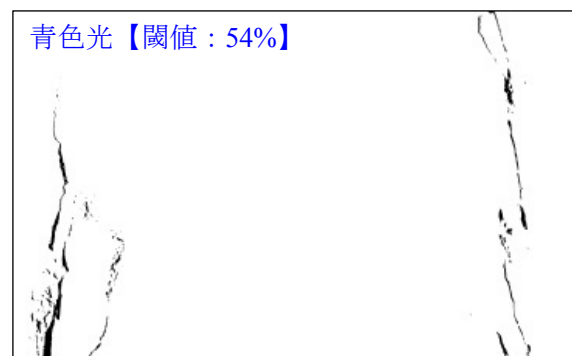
写真-1 の供試体からひび割れを抽出した二値化画像
